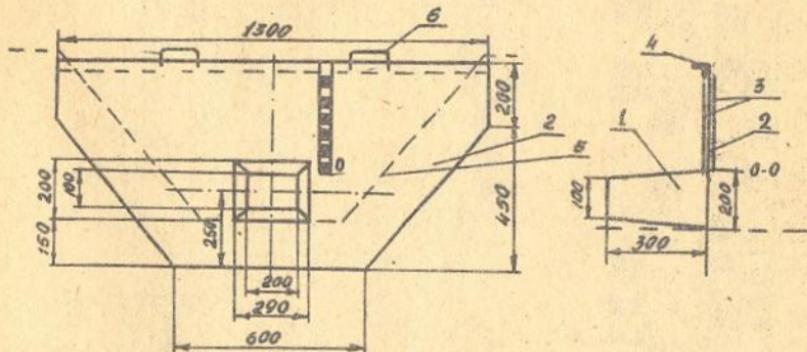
Водомерный насадок ВН-25х50: 1 - насадок;
